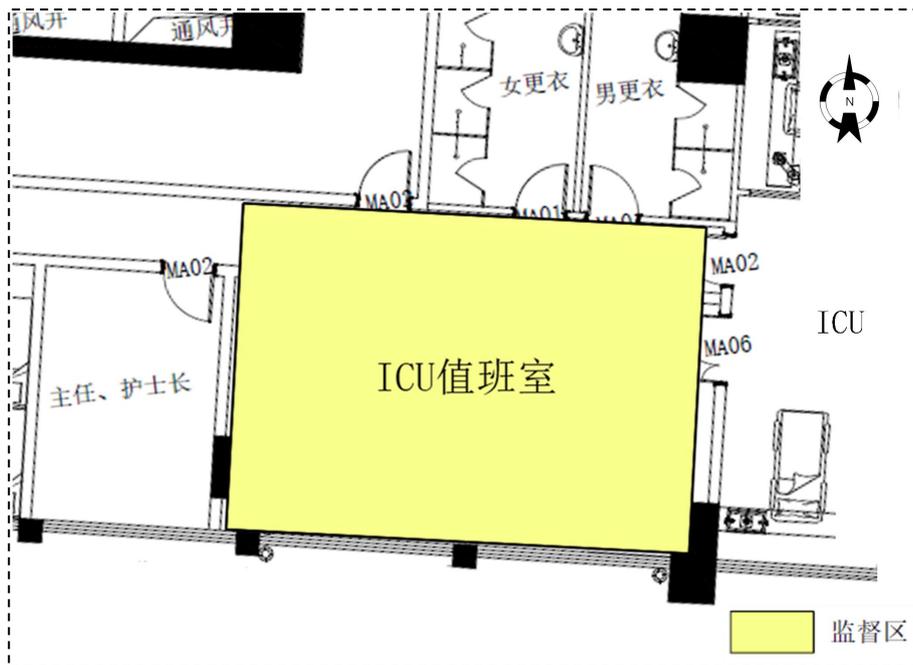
1 号楼六楼（DSA 机房上方楼层）平面布置及分区示意图
